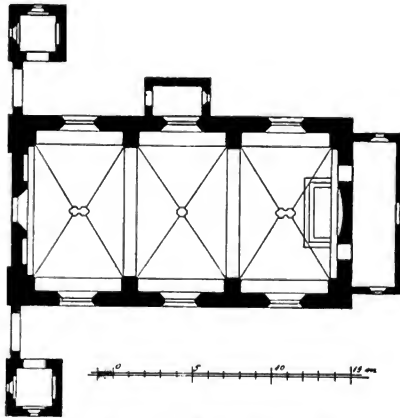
Grundriß der Wallfahrtskirche zu Schönwiefe.
